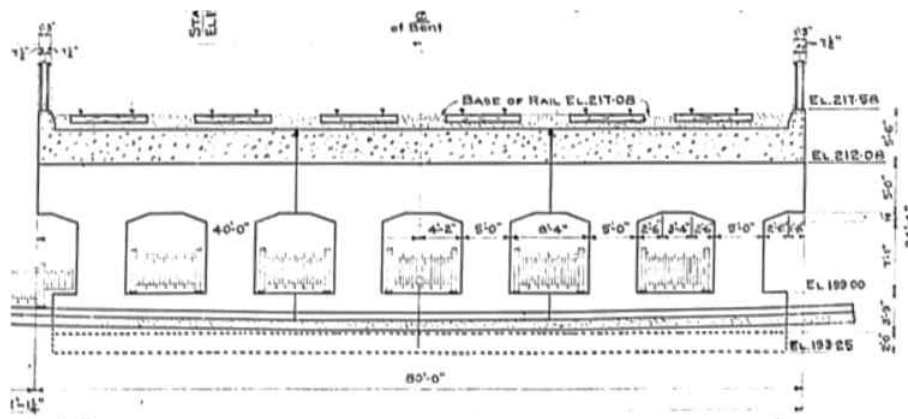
Pont ferroviaire P.F. 81-5170B – Extrait des plans 5170-1951 - Coupe type du tablier et pile existante
